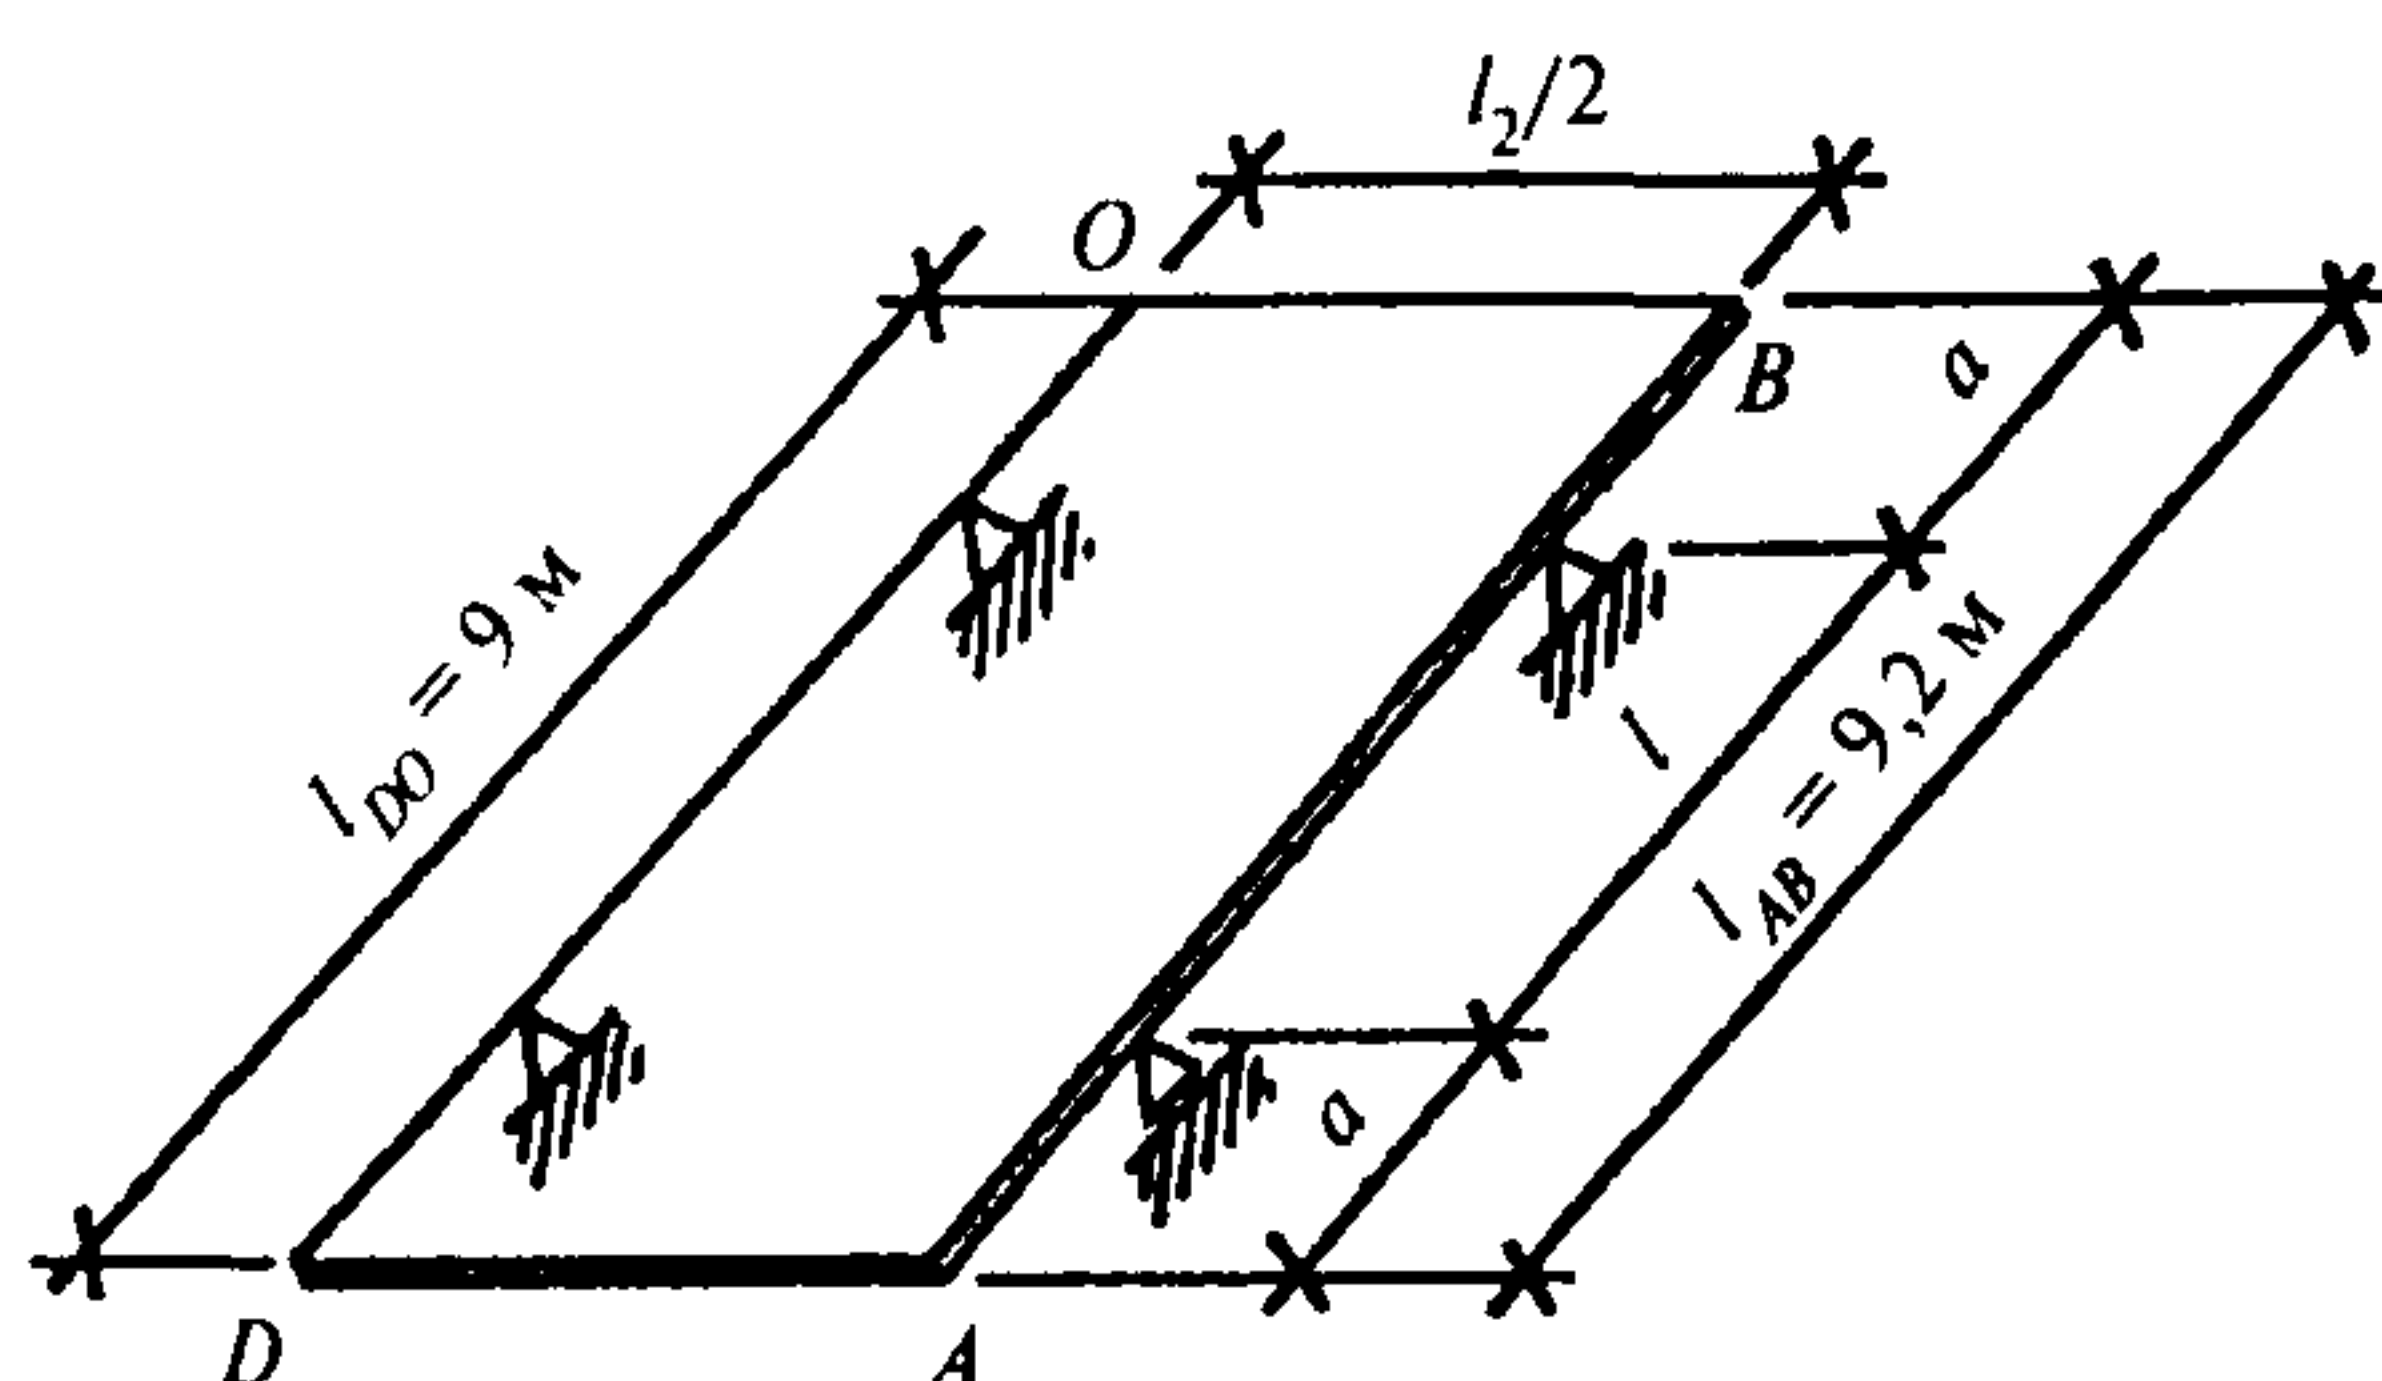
Схема опирания гиперболической панели в расчете на монтажные нагрузки
